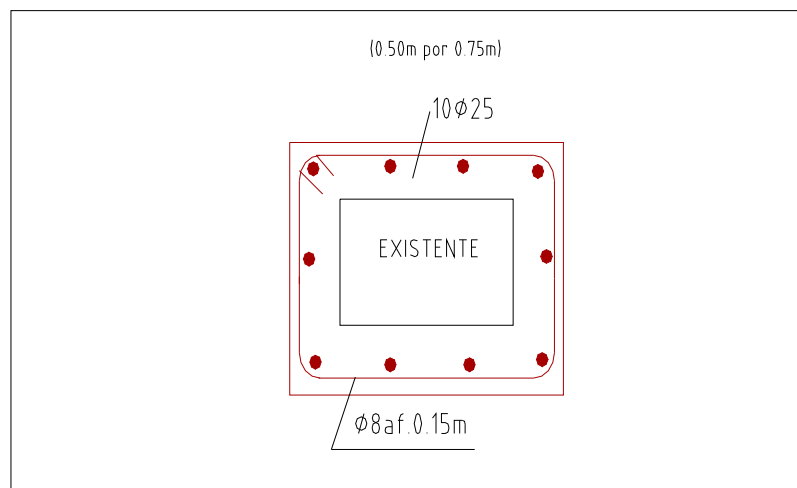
Pormenorização da solução de reforço por encamisamento dos pilares com betão.
